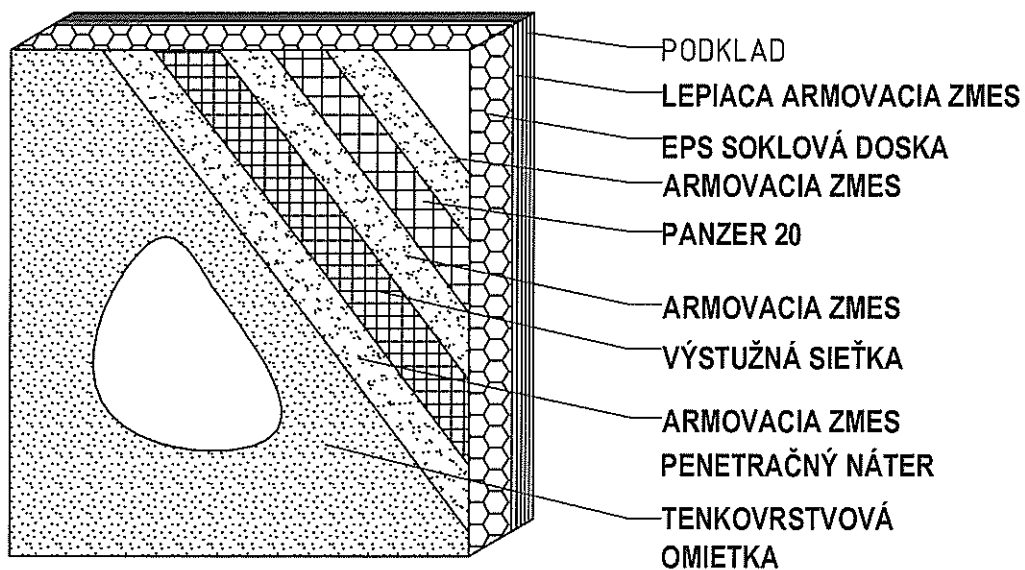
DETAIL - VYBRANÉ ZÁSADY ZATEPLOVANIA
